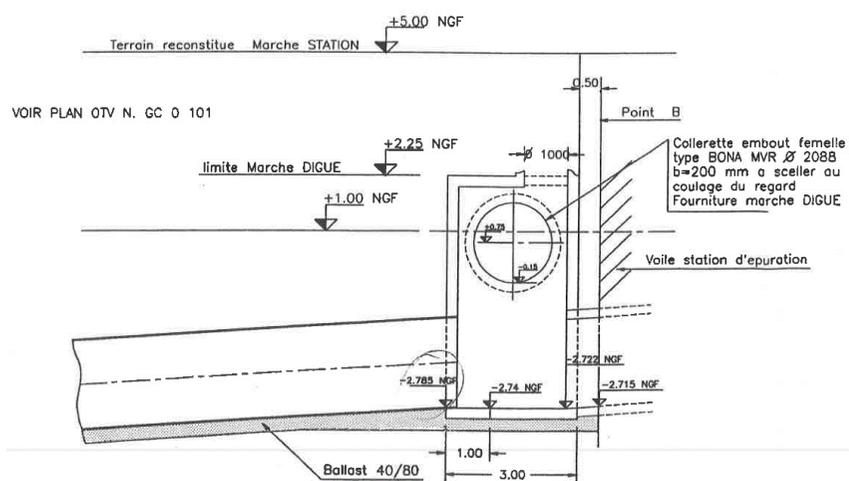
Coupe Chambre de Raccordement à Terre (source Plan d'exécution Émissaire sous digue SPADA 1993)
